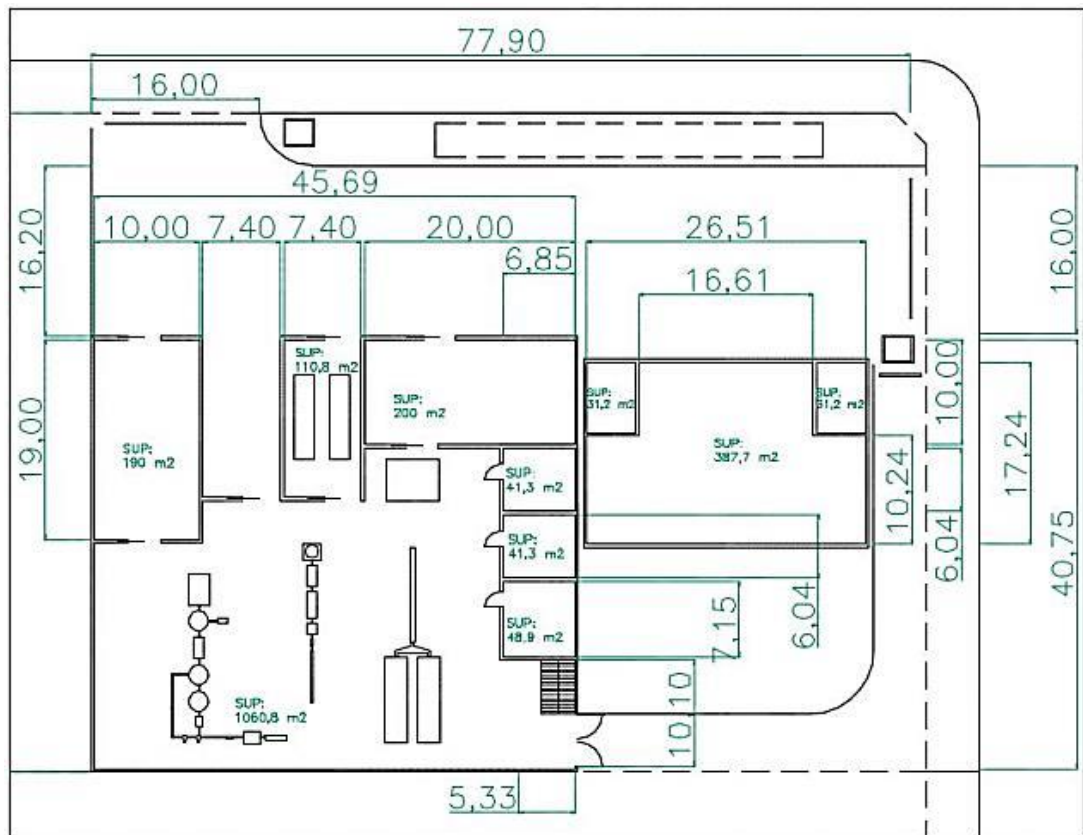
Superficies y cotas del lay out. Planta baja.
